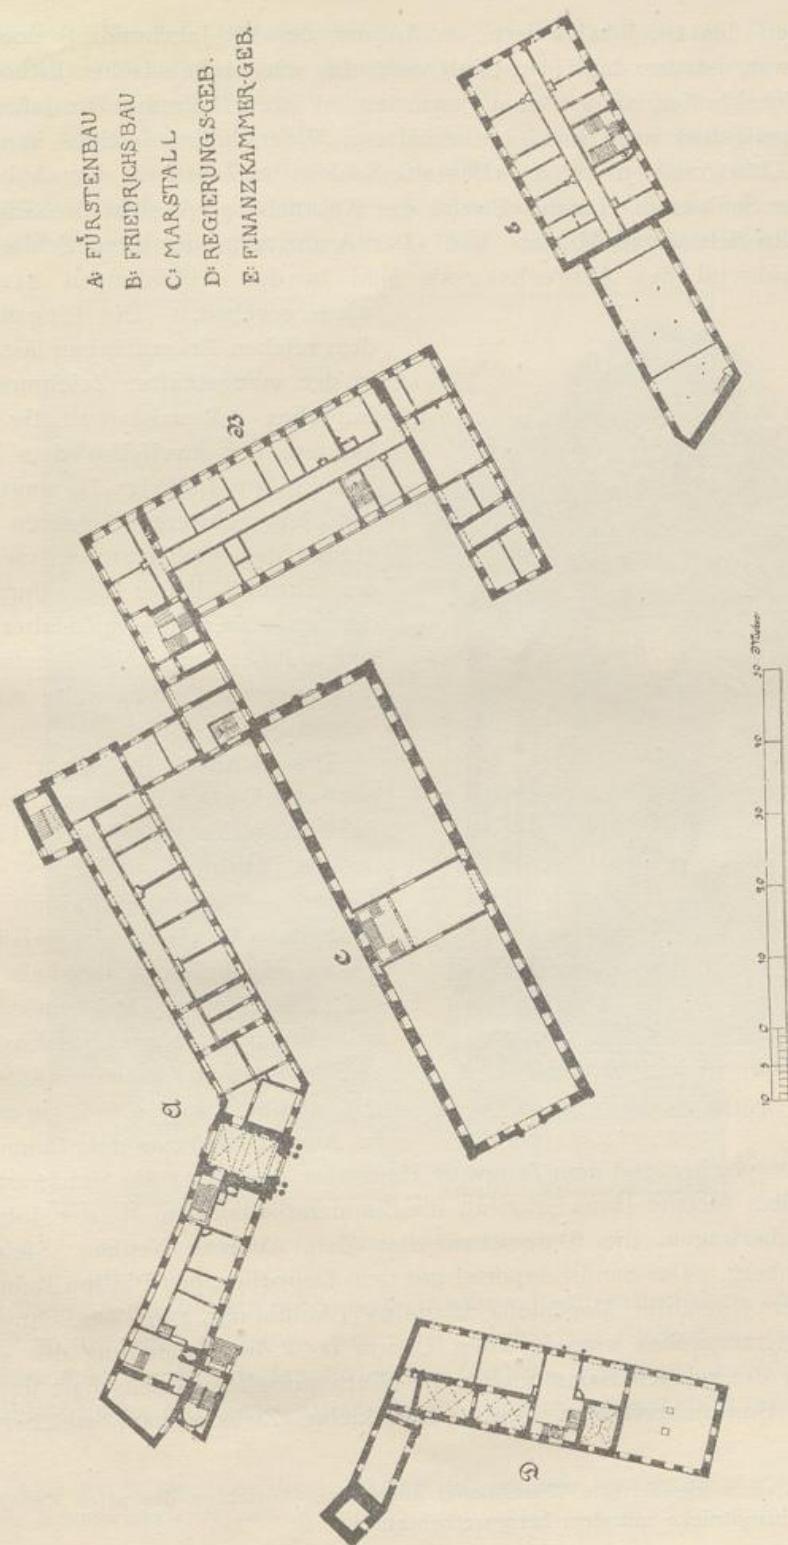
Gegenwärtiger Grundriss des Schlosses.
